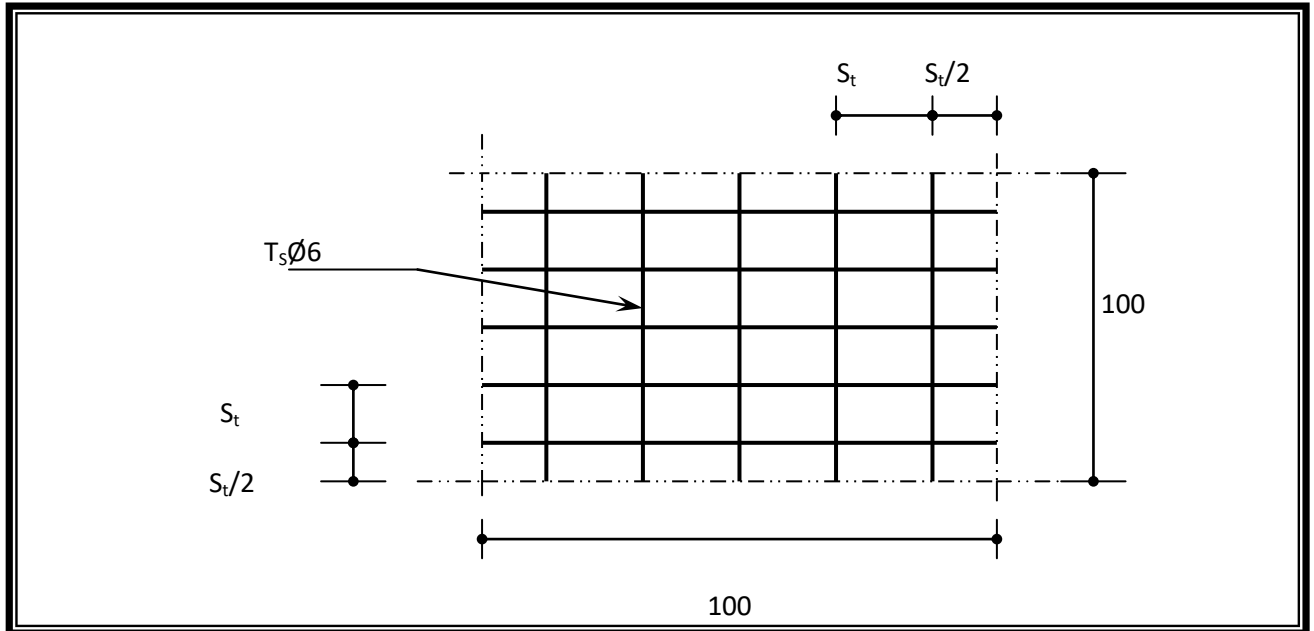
Disposition constructive des armatures de la dalle de compression.
